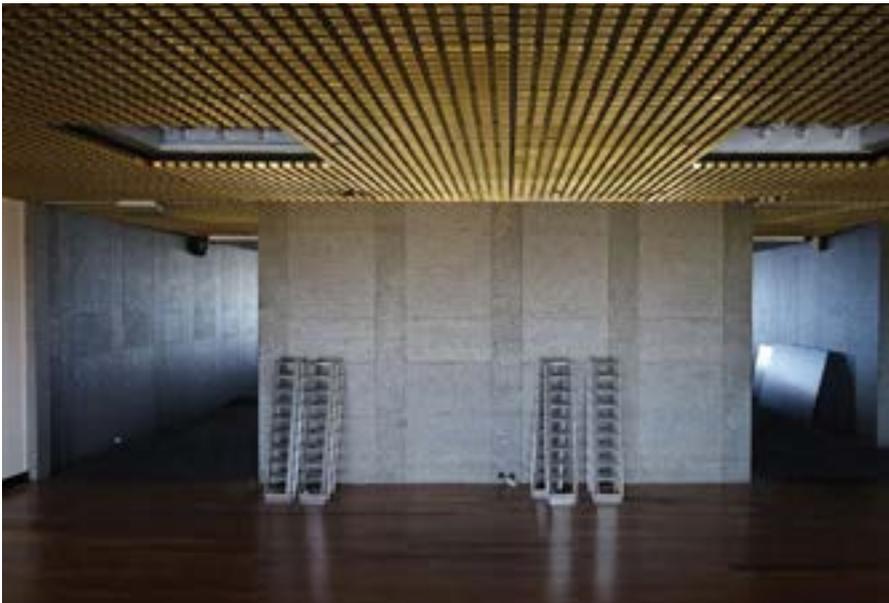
Projet de déconstruction de la Bnp Paribas, façade en granit et faux-plafond en métal doré (photo, Rotor)
